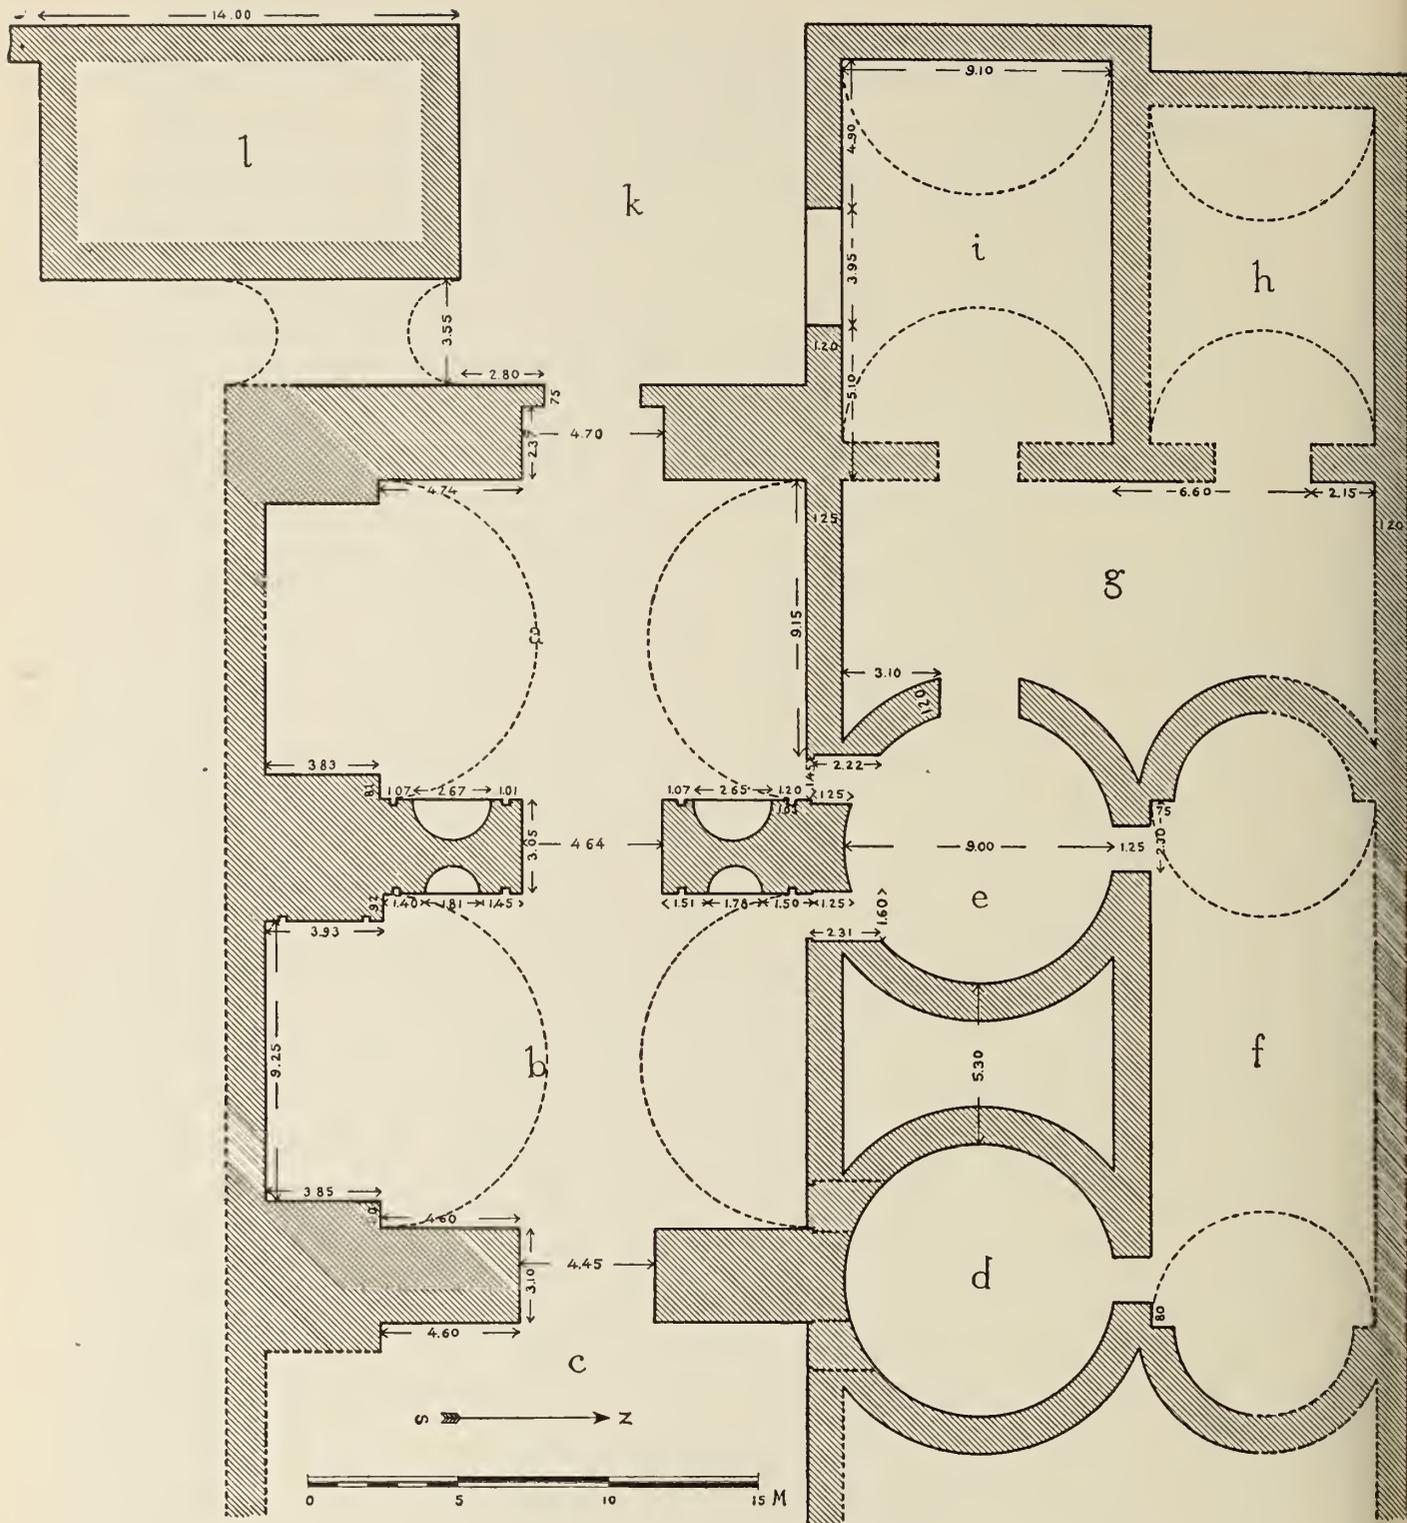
eš-Šuhba: Thermen: Grundriß.
